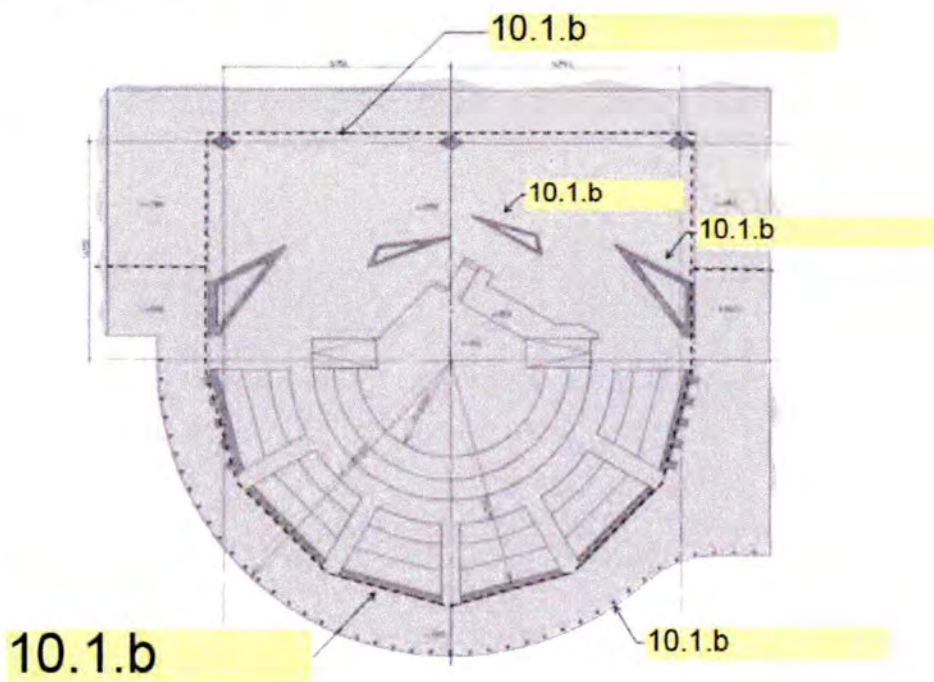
; Doorsnede van de hoofdconstructie van de plenaire zaal (oorspronkelijke afbeelding afkomstig uit artikel van hoofdconstructeur D3BN, Cement 1991-12 voorzien van opmerkingen).
